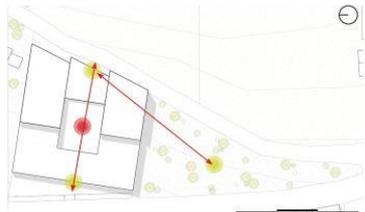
Accesibilidad al elemento arquitectónico. (Autor)
